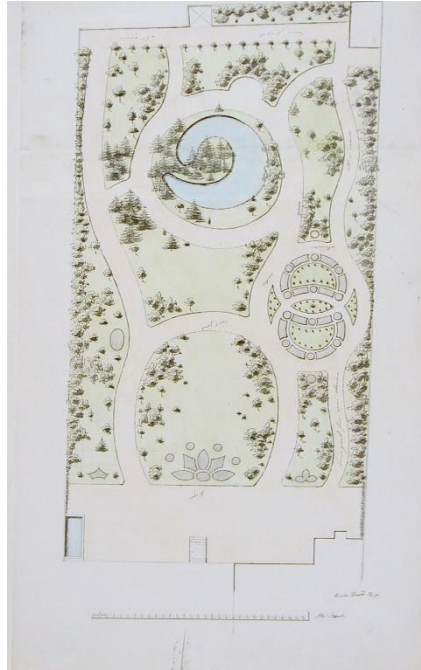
Planta do jardim da casa da Rua de Cedofeita
